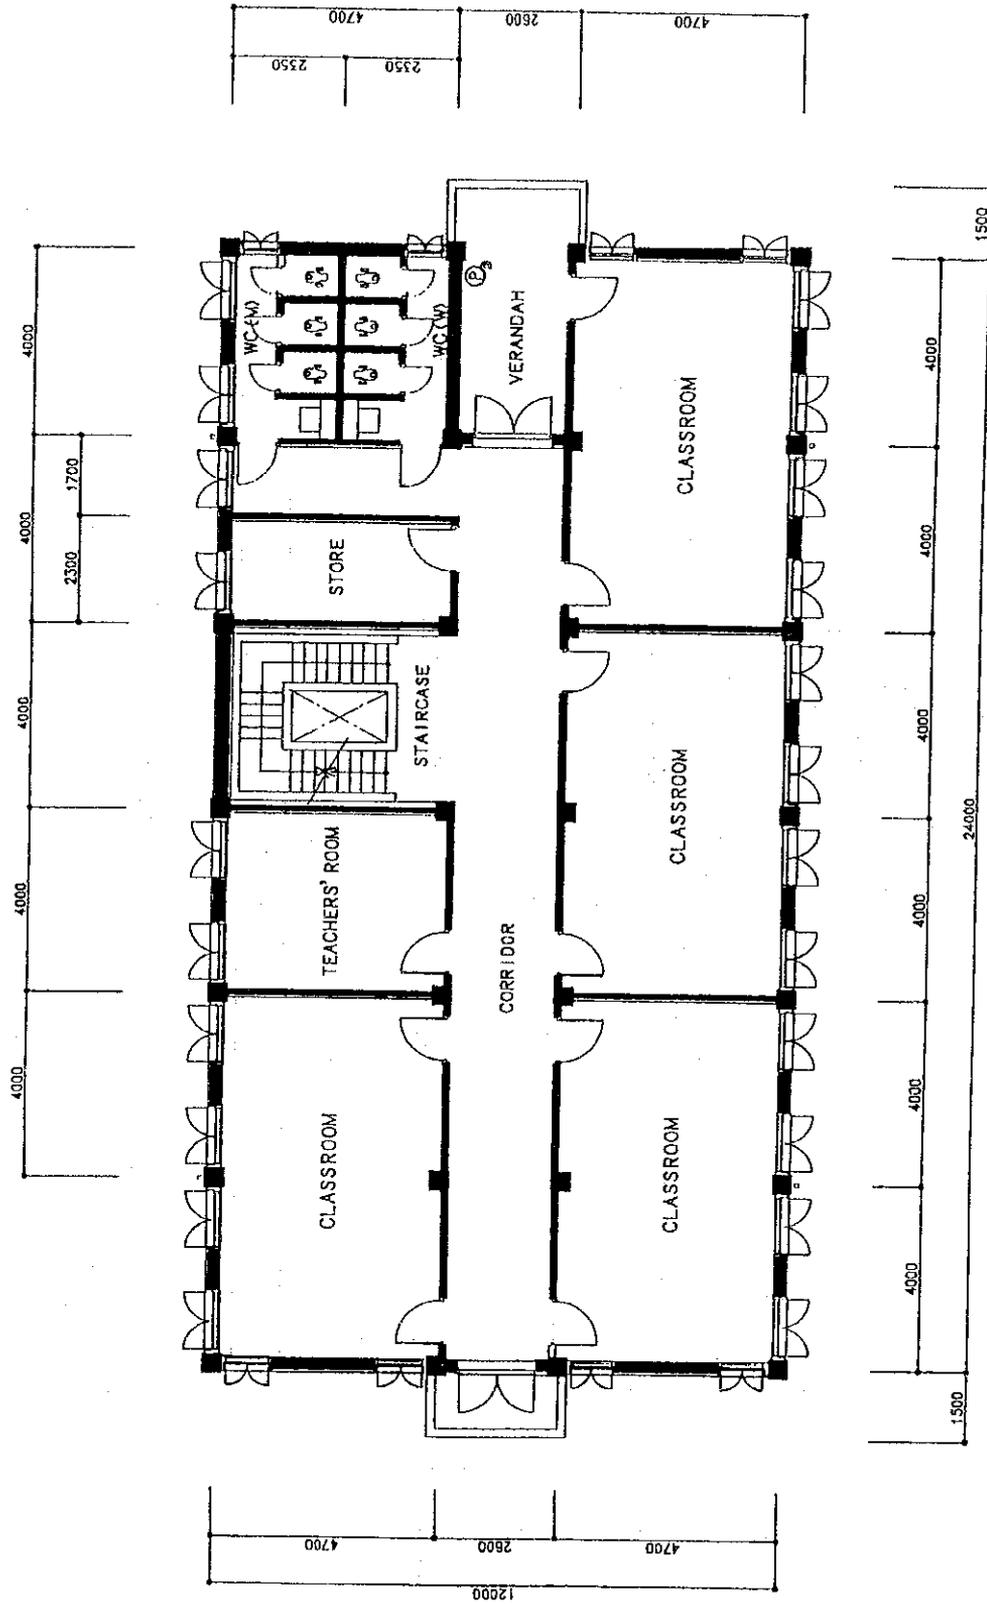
(2) 2 階平面図 (4 教室タイプ)
